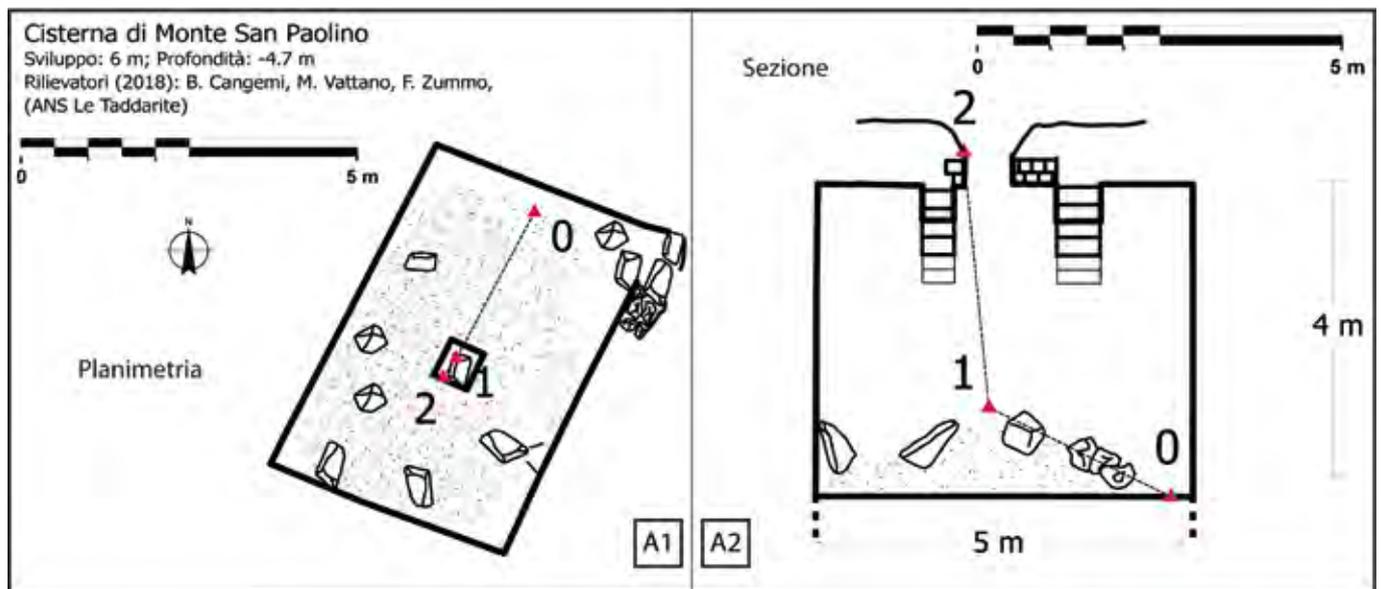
Rilievo topografico ipogeo con planimetria (A1) e sezione longitudinale estesa (A2) della Cisterna di Monte San Paolino.
